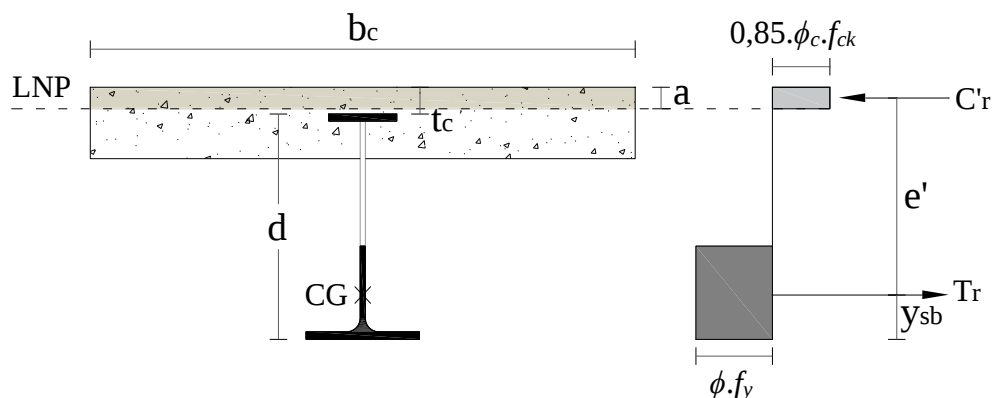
Modelo de cálculo para a linha neutra plástica posicionada na laje de concreto acima do perfil
